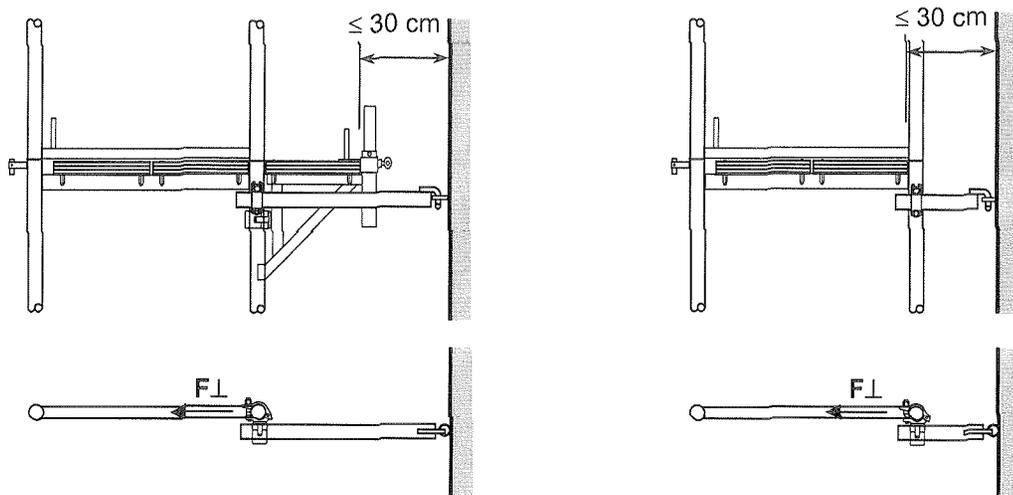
Höhenlage der Gerüsthalter bei Anschluss im „Knoten“.
